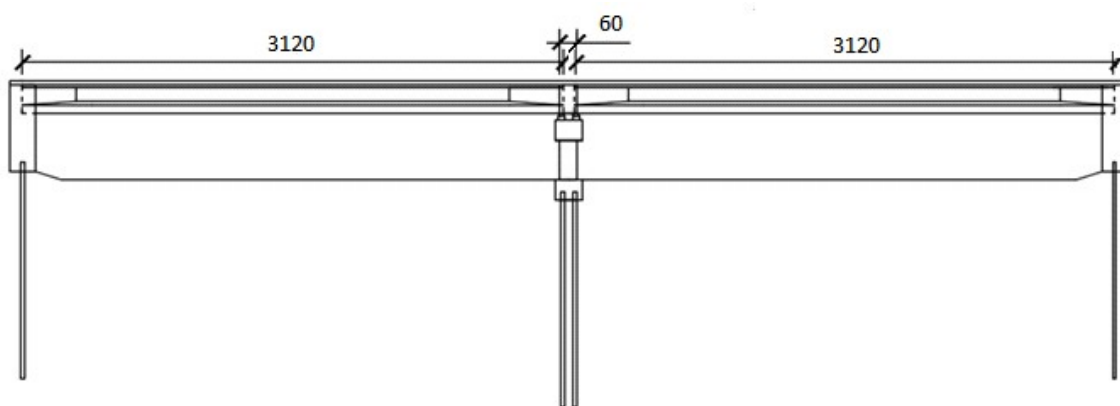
2: Elevação longitudinal - modelo integral (medidas em cm).
